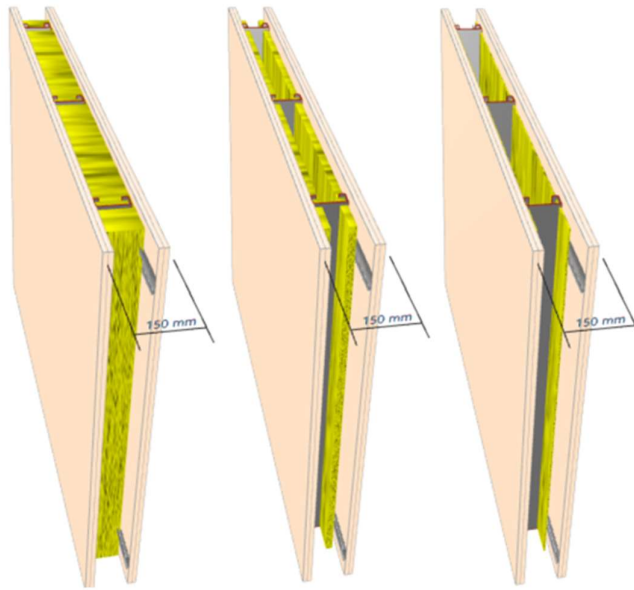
Perfil em C com barra resiliente horizontal e uma placa de gesso. Isolamento de 100, 50 e 10 mm respectivamente.
